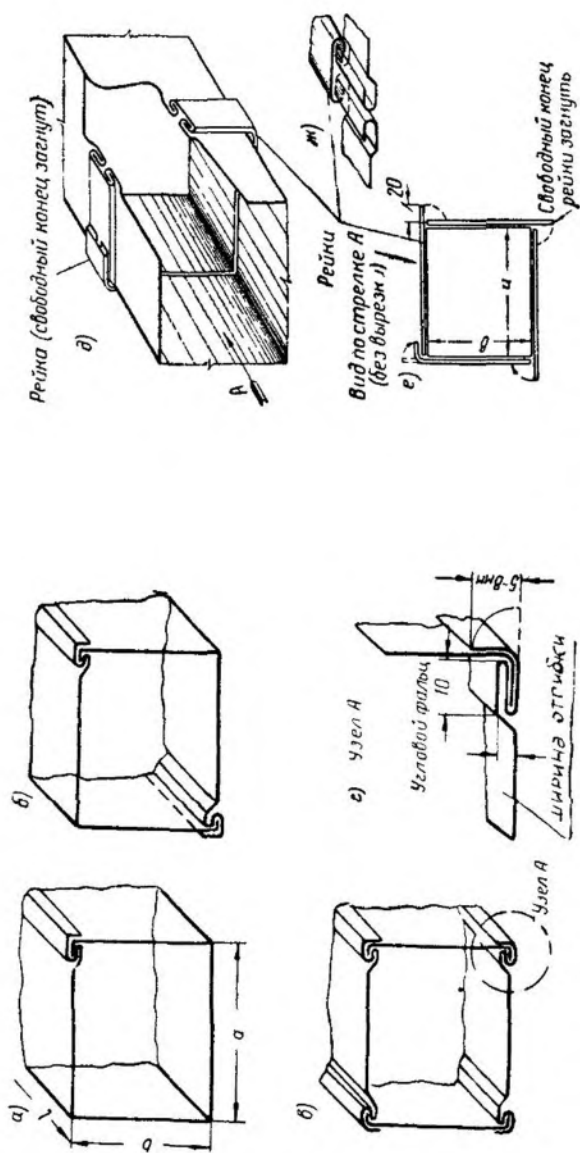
Виды угловых соединений воздуховодов прямоугольного сечения и соединение звеньев рейками
